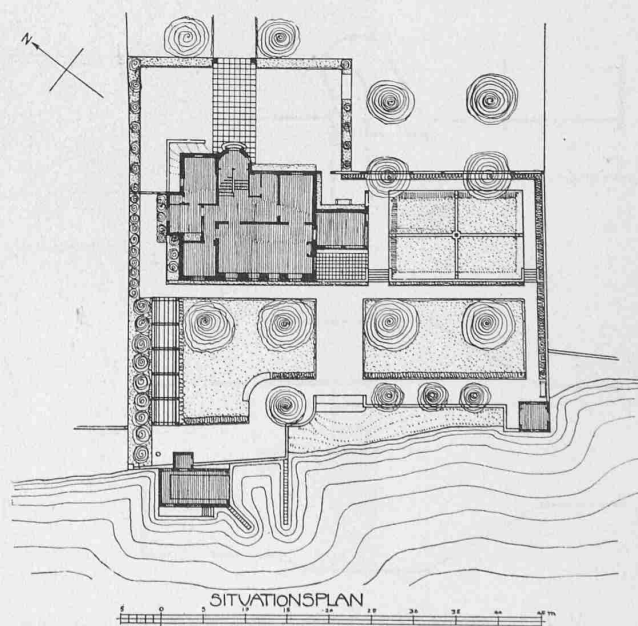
Lageplan vom Landhaus und Garten Dr. Jung in Küsnacht.
